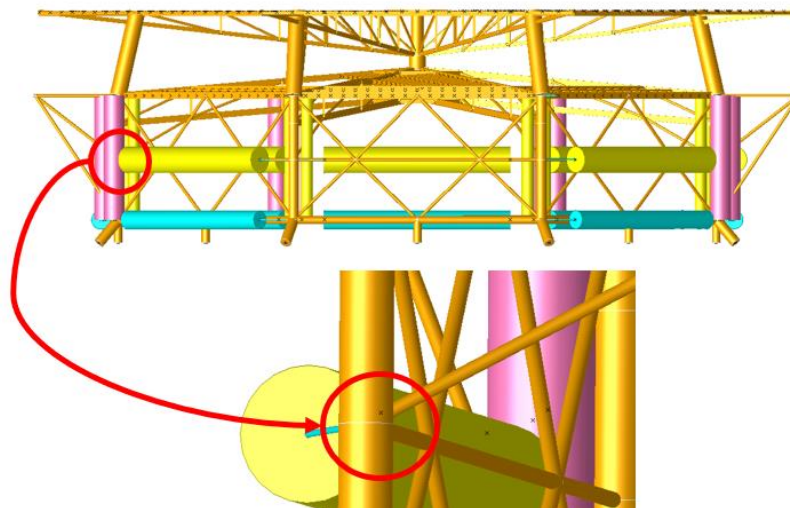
Joint Pada Buoyancy Frame Bagian Bawah (K Brace)
